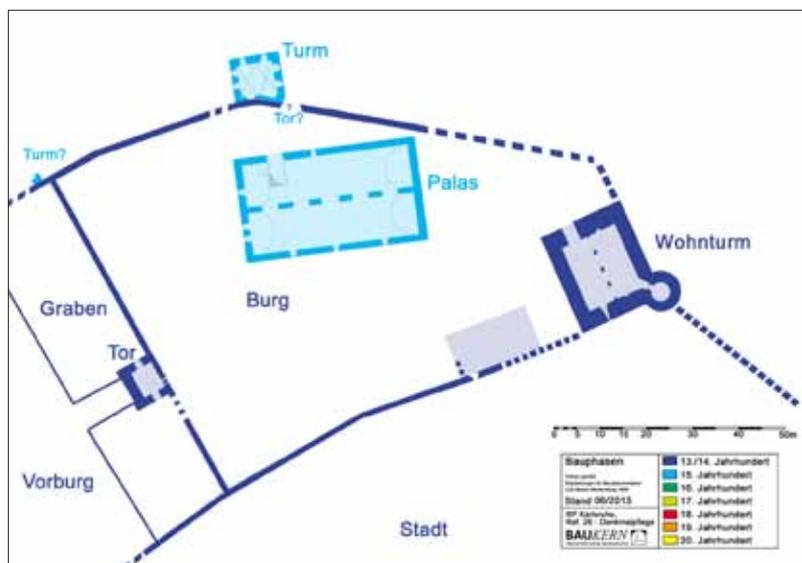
Rekonstruierter Grundriss des „Neuen Schlosses“ im 14. Jahrhundert.
